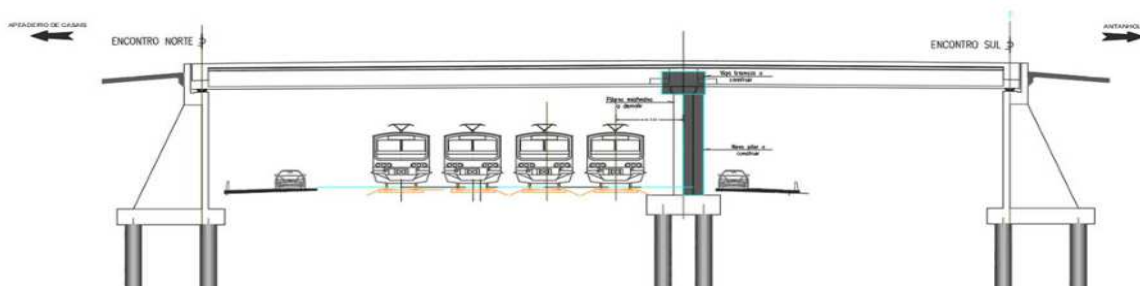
Corte longitudinal da PSR ao pk 212+538 com o novo pilar
